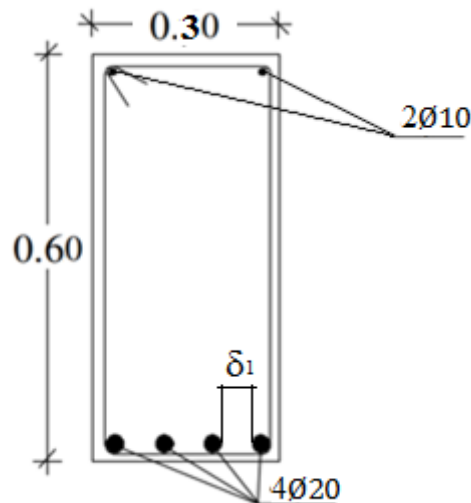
Armadura das Vigas segundo o eixo x (Corte Transversal)
